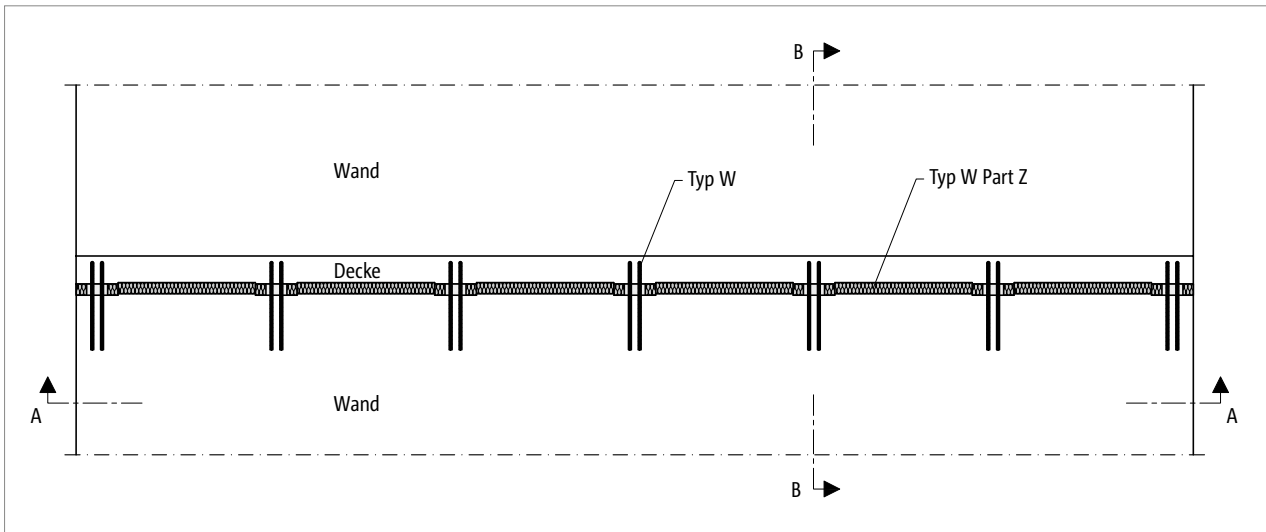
Schöck Sconnex® Typ W: Anschluss zwischen Wand und darüberliegender Decke – Einbau am Wandkopf
